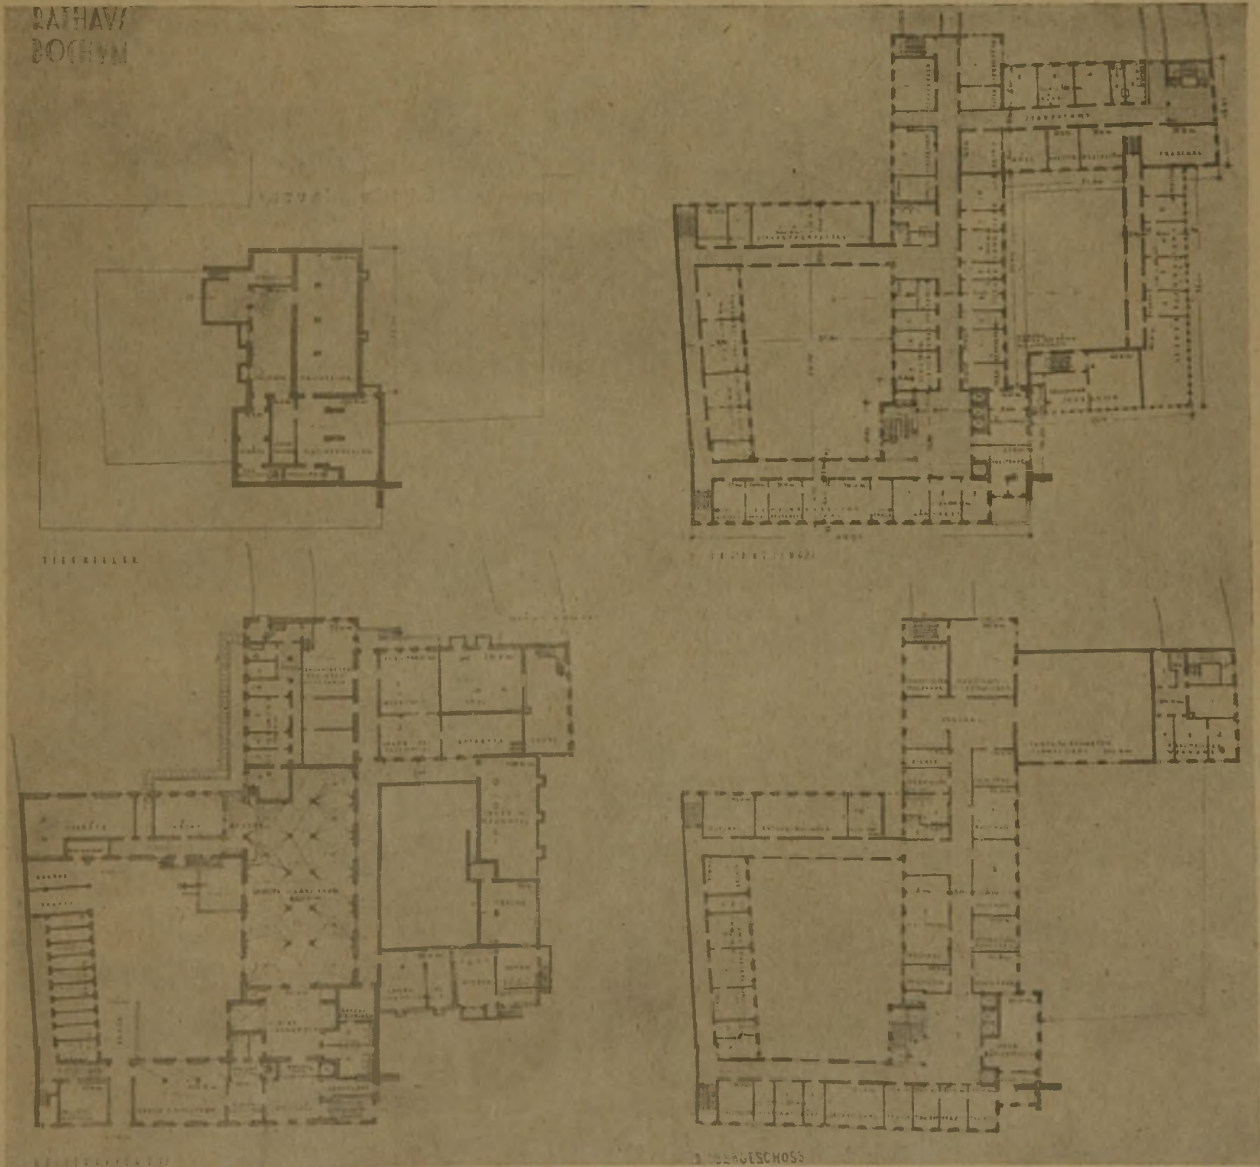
9. Grundrisse der Kellergeschosse, des I. u. II. Obergeschosses. (1 : 1750.)
